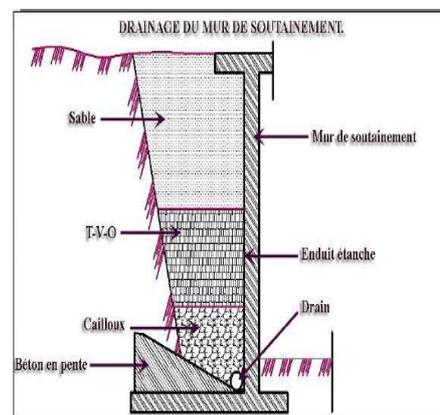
DETAIL MUR DE SOUTÈNEMENT
